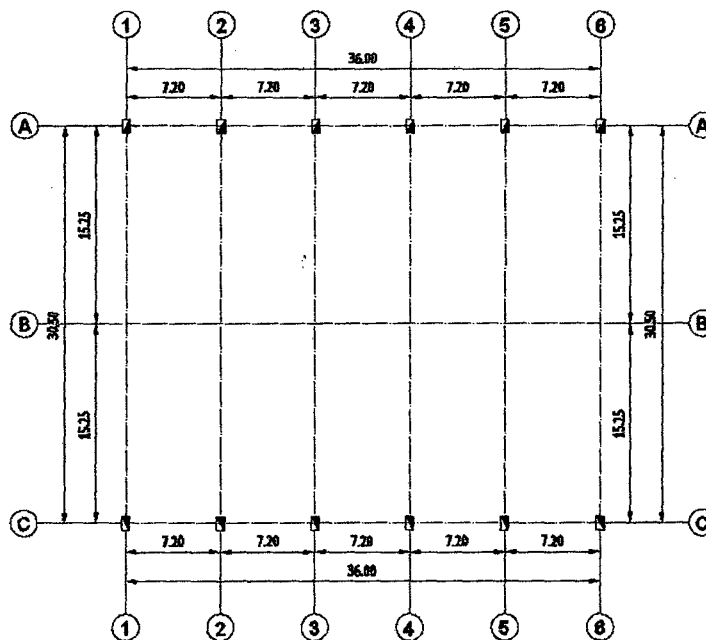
3: Planta de elementos estructurales base para el proceso de diseño.
